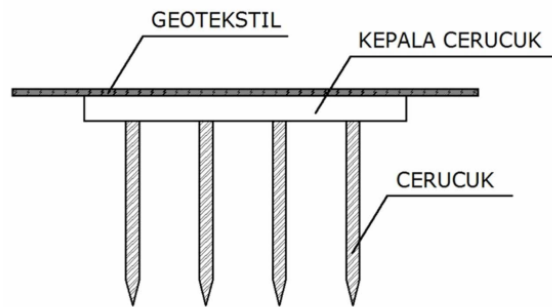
Pondasi *Footplat* dengan Cerucuk.
